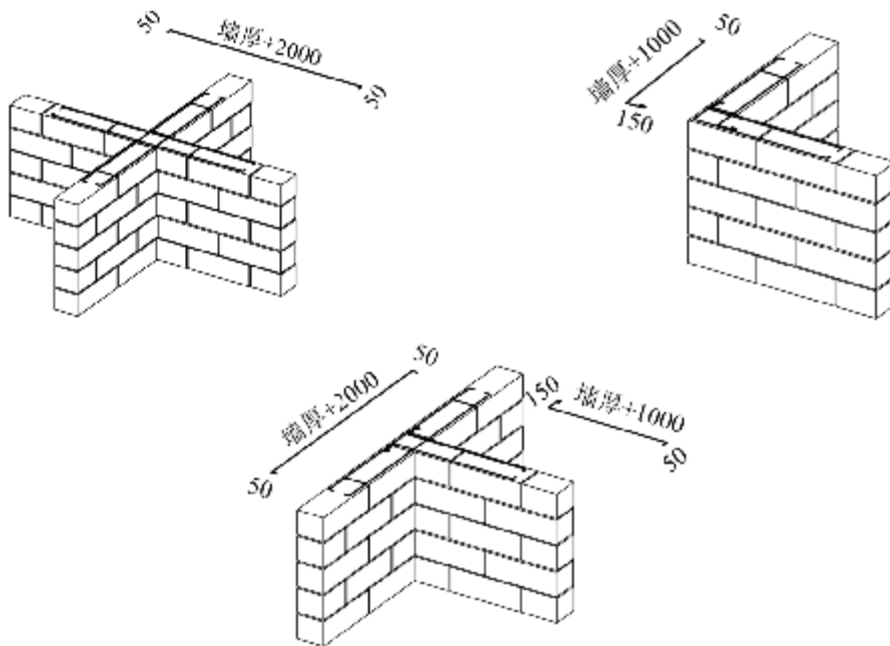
纵横墙连接处拉结钢筋做法（单位：mm）
